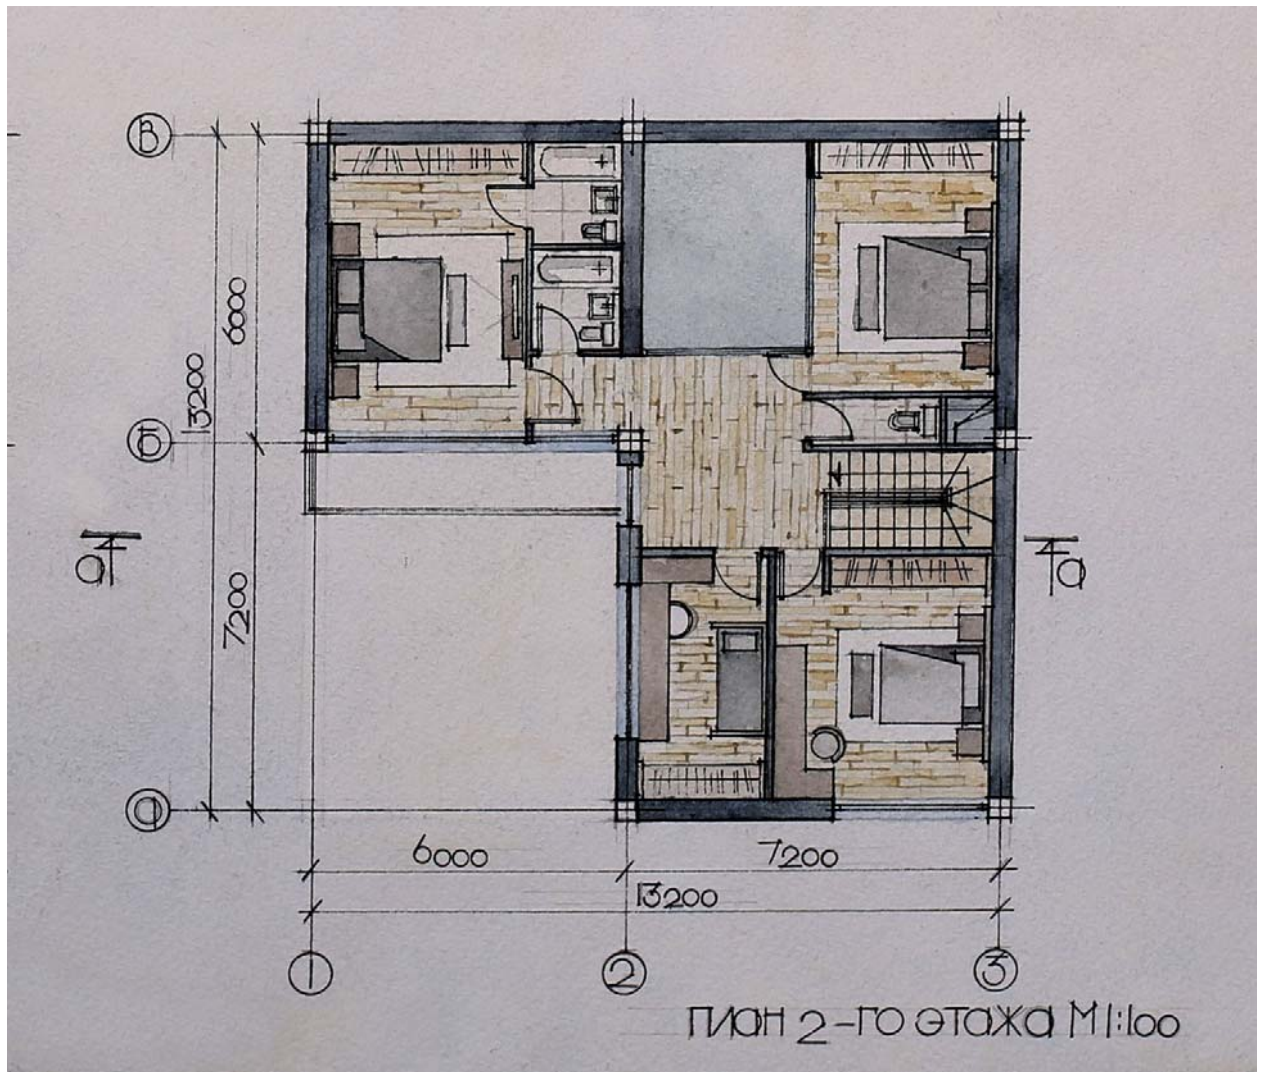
Проект 2-х этажного жилого дома. План 2-го этажа
